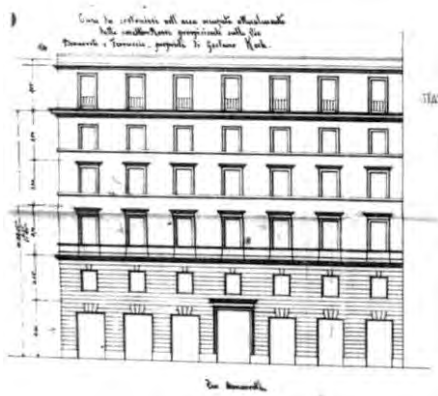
casa in via Buonarroti prospetto su via Buonarroti
